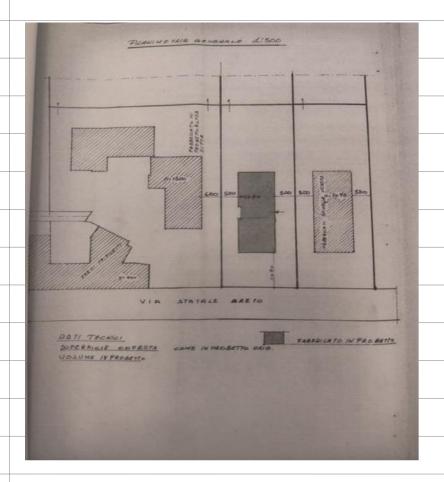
planimetria generale scala 1:500 concessione edilizia variante n. 2608030789
